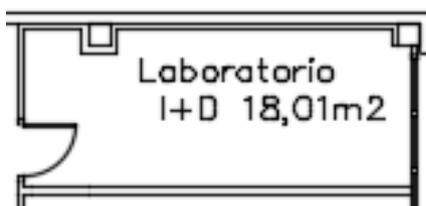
Laboratorio I+D. Fuente: Elaboración propia
